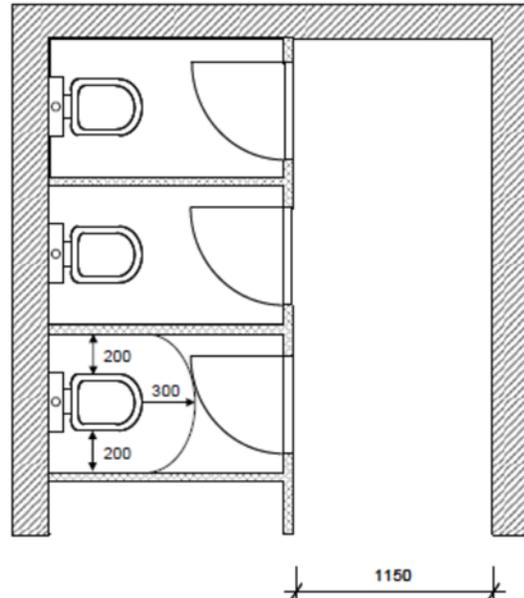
Einbündige Toilettenanlage, Türanschlag nach innen (Maße in mm)
